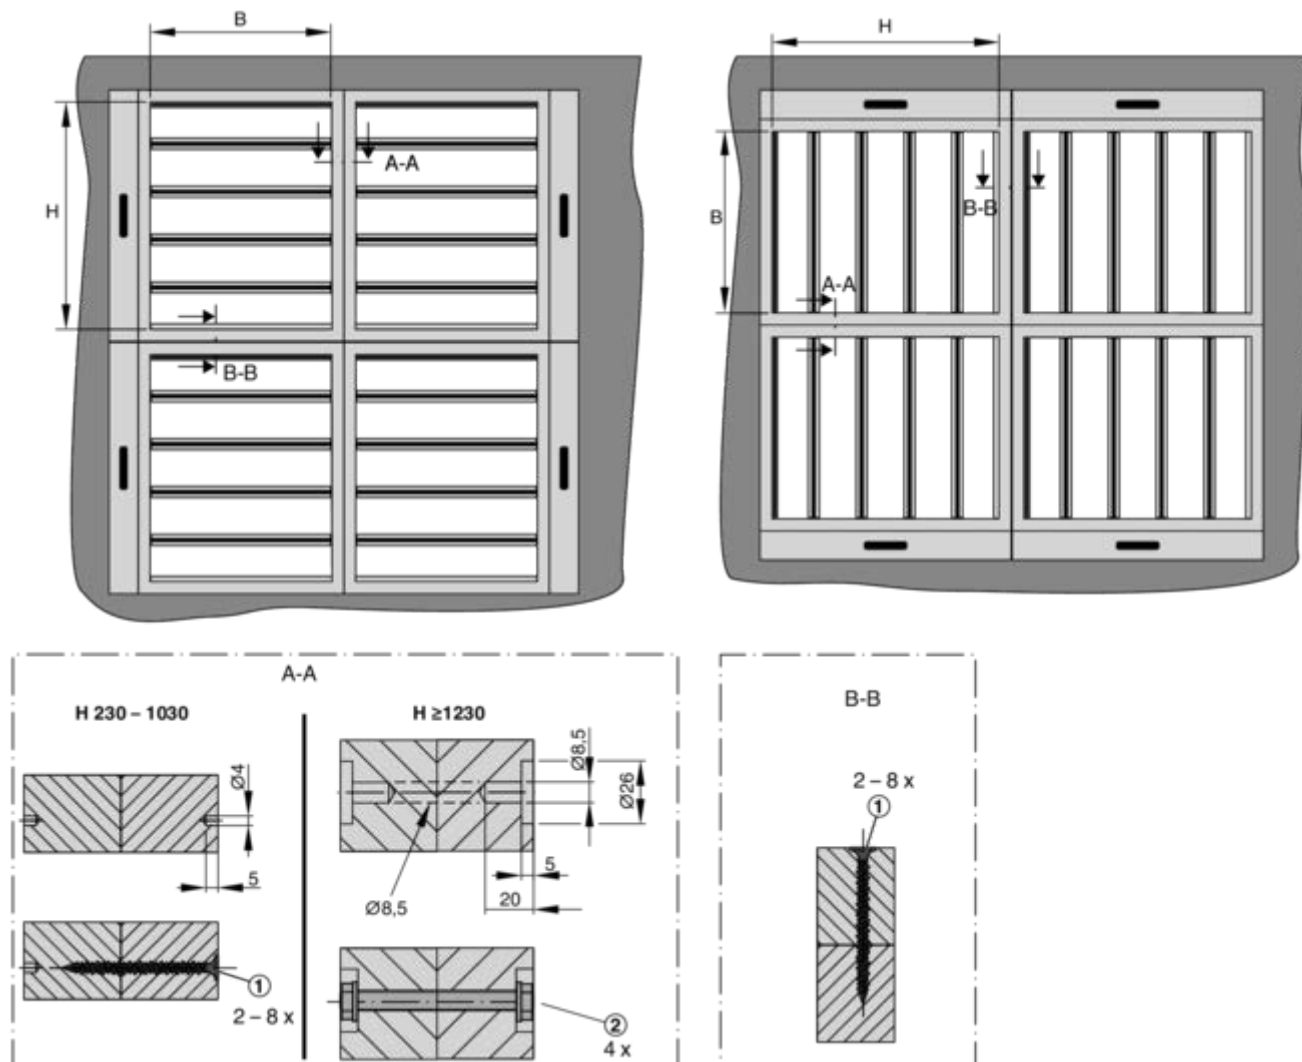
Serranda a serranda EK-JZ, multipla, posizione dell'asse della pala della serranda orizzontale e verticale
